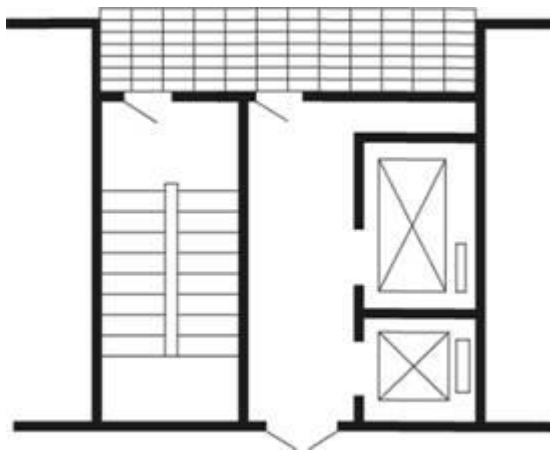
Незадымляемая лестница с переходом через балкон или лоджию
